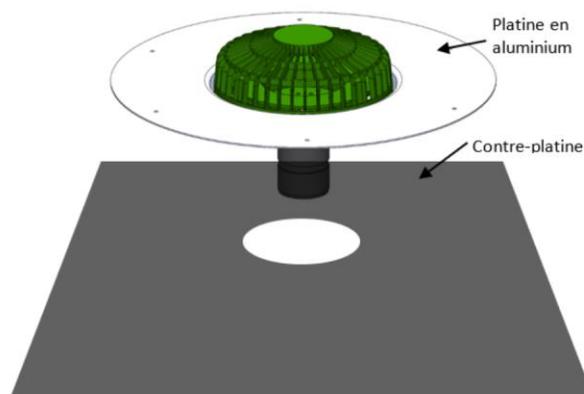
La contre-platine bitumineuse est soudée sur la platine aluminium
